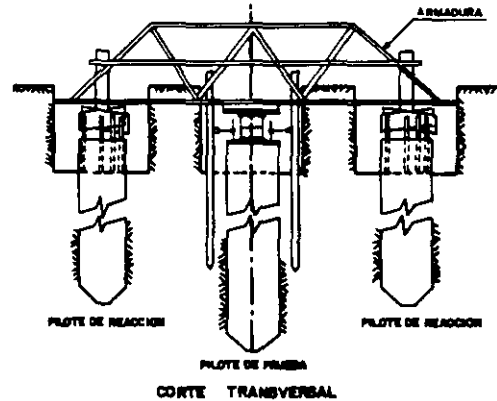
DETALLE DE ESTRUCTURA Y DE LOS PILOTES PARA LAS PRUEBAS DE CARGA.
